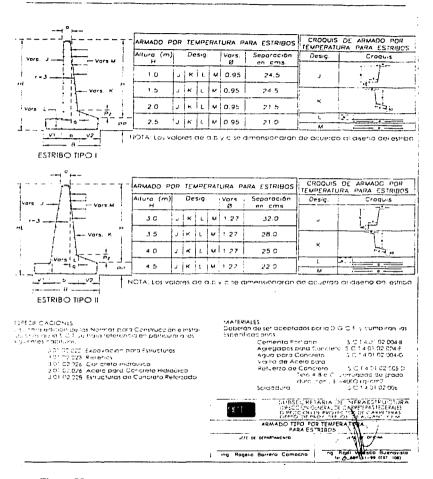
Proyectos tipo para armado por temperatura para estribos de Concreto .
